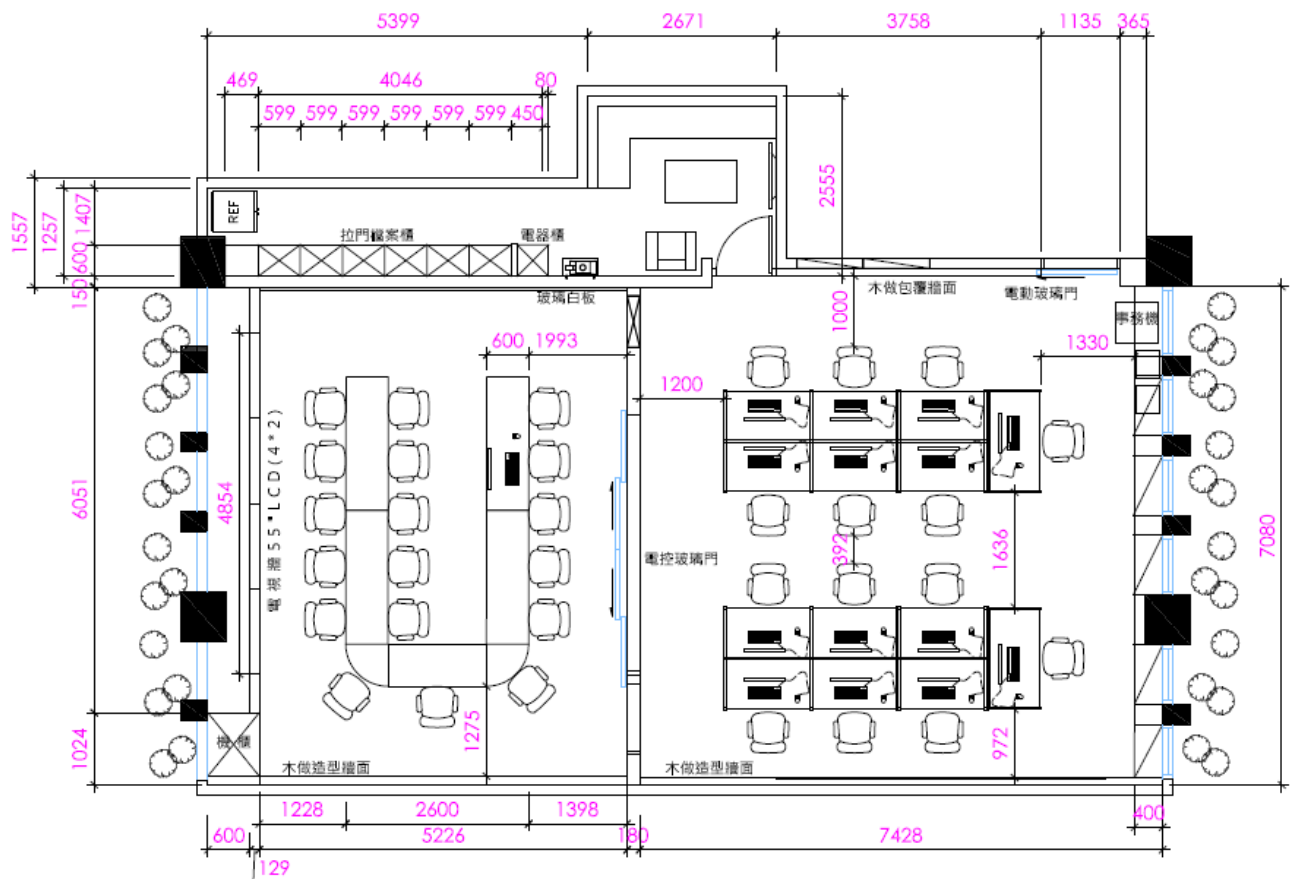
方案 E 智慧交通中心平面配置圖
